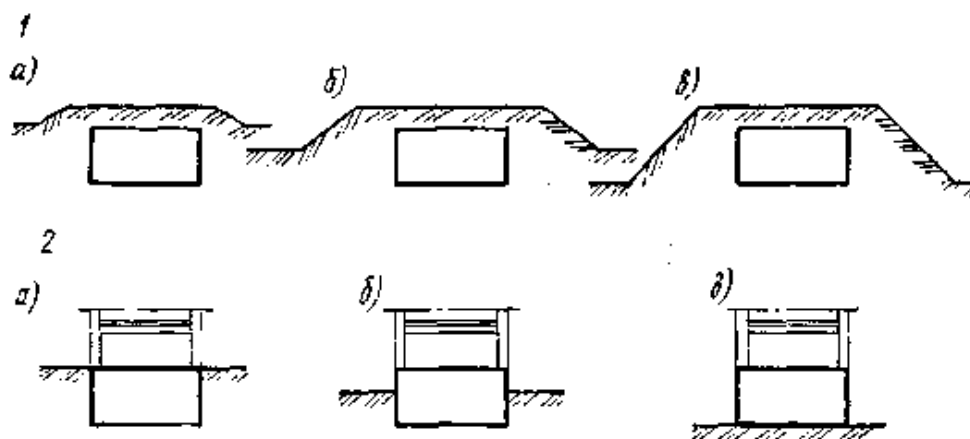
Схема вертикальної посадки захисних споруд: 1 – окремо розташована захисна споруда: а – заглиблена; б – напівзаглиблена; в – підвищена; 2 – вбудована захисна споруда: а – підвальна; б – напівпідвальна; в – на першому поверсі будівлі.
